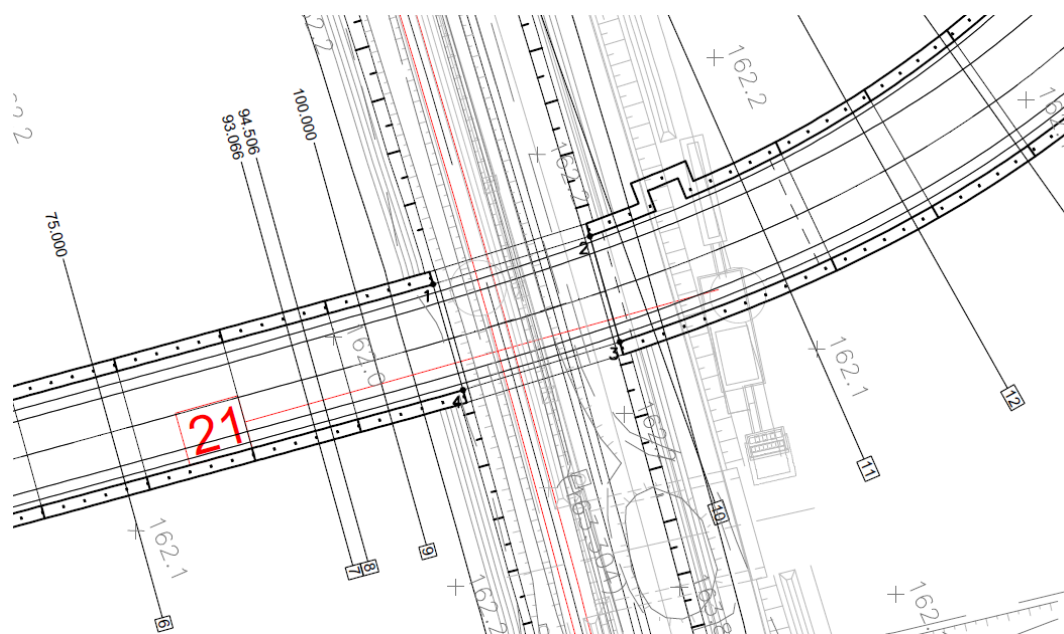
PLANIMETRIA SOTTOVIA SLO2
